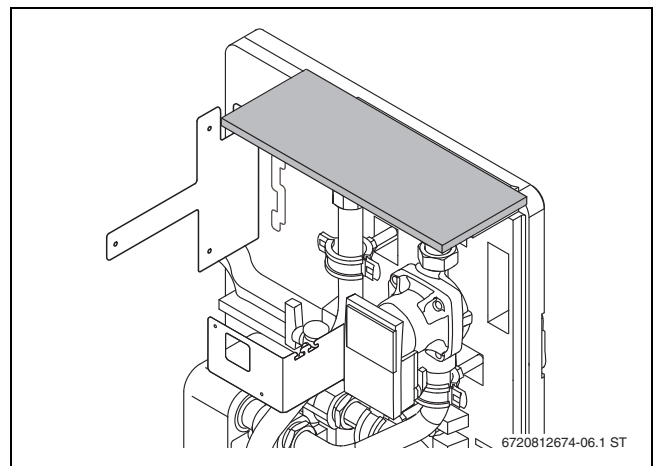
Anschlüsse oben während der Montagearbeiten abdecken
